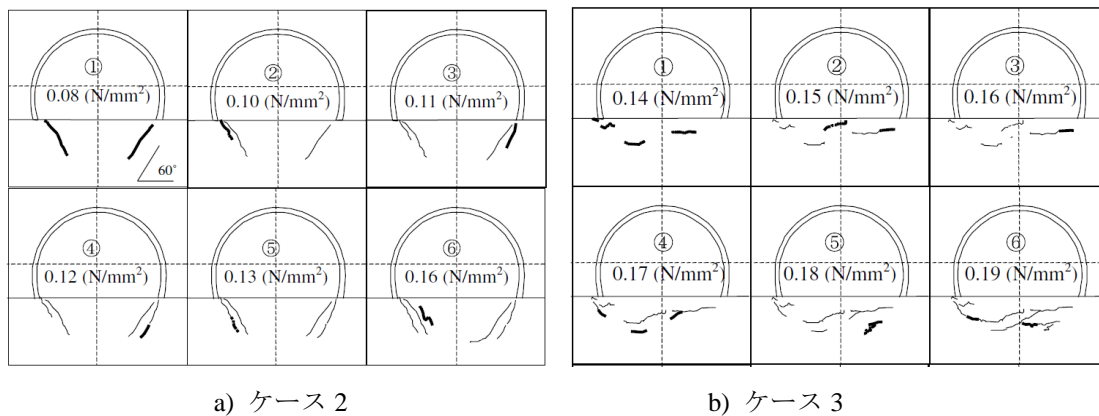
トンネル下部地山ひび割れ進展状況³⁾
